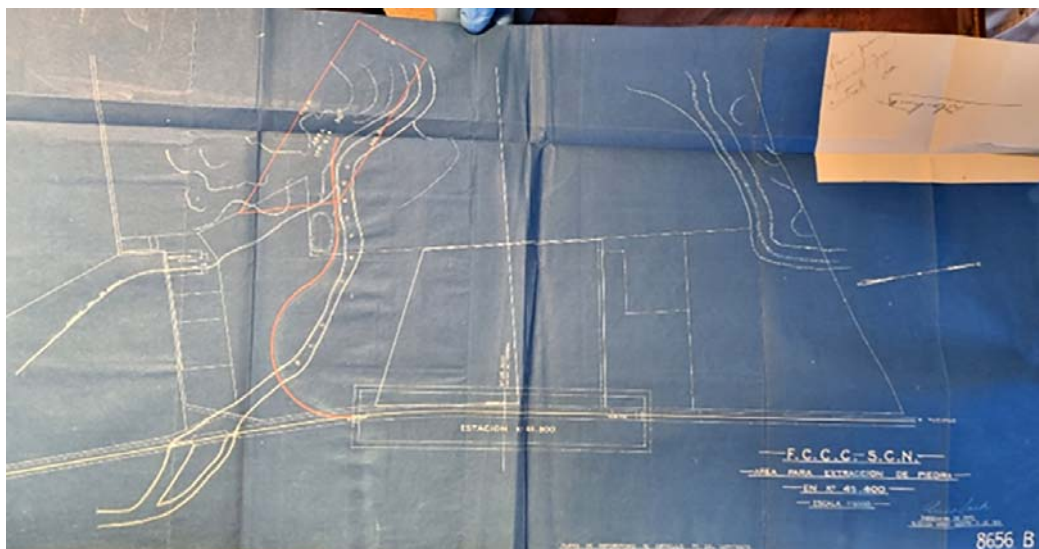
Plano de cesión de Vicente Abburrá a Ferrocarril Central Córdoba (1913).
